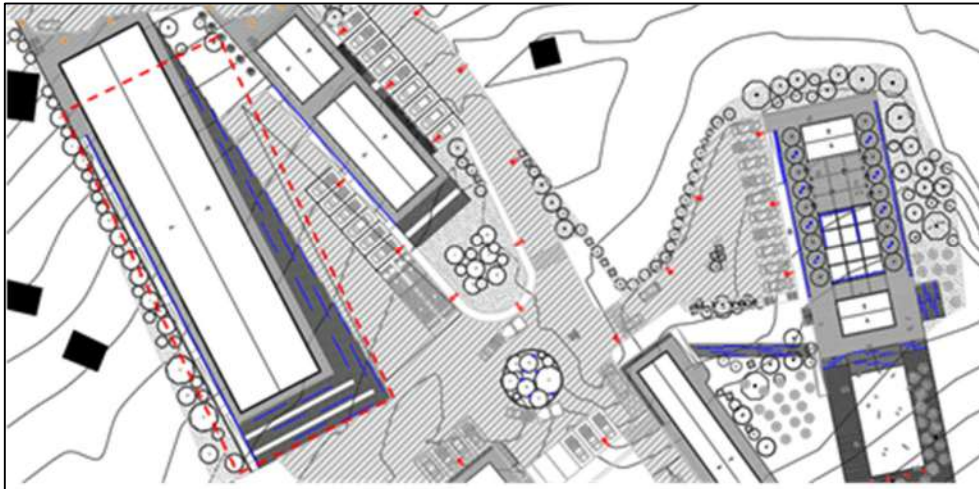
LAYOUT DE LUMINARIAS EN ESCALERAS Y RAMPAS BAJO PASAMANO
